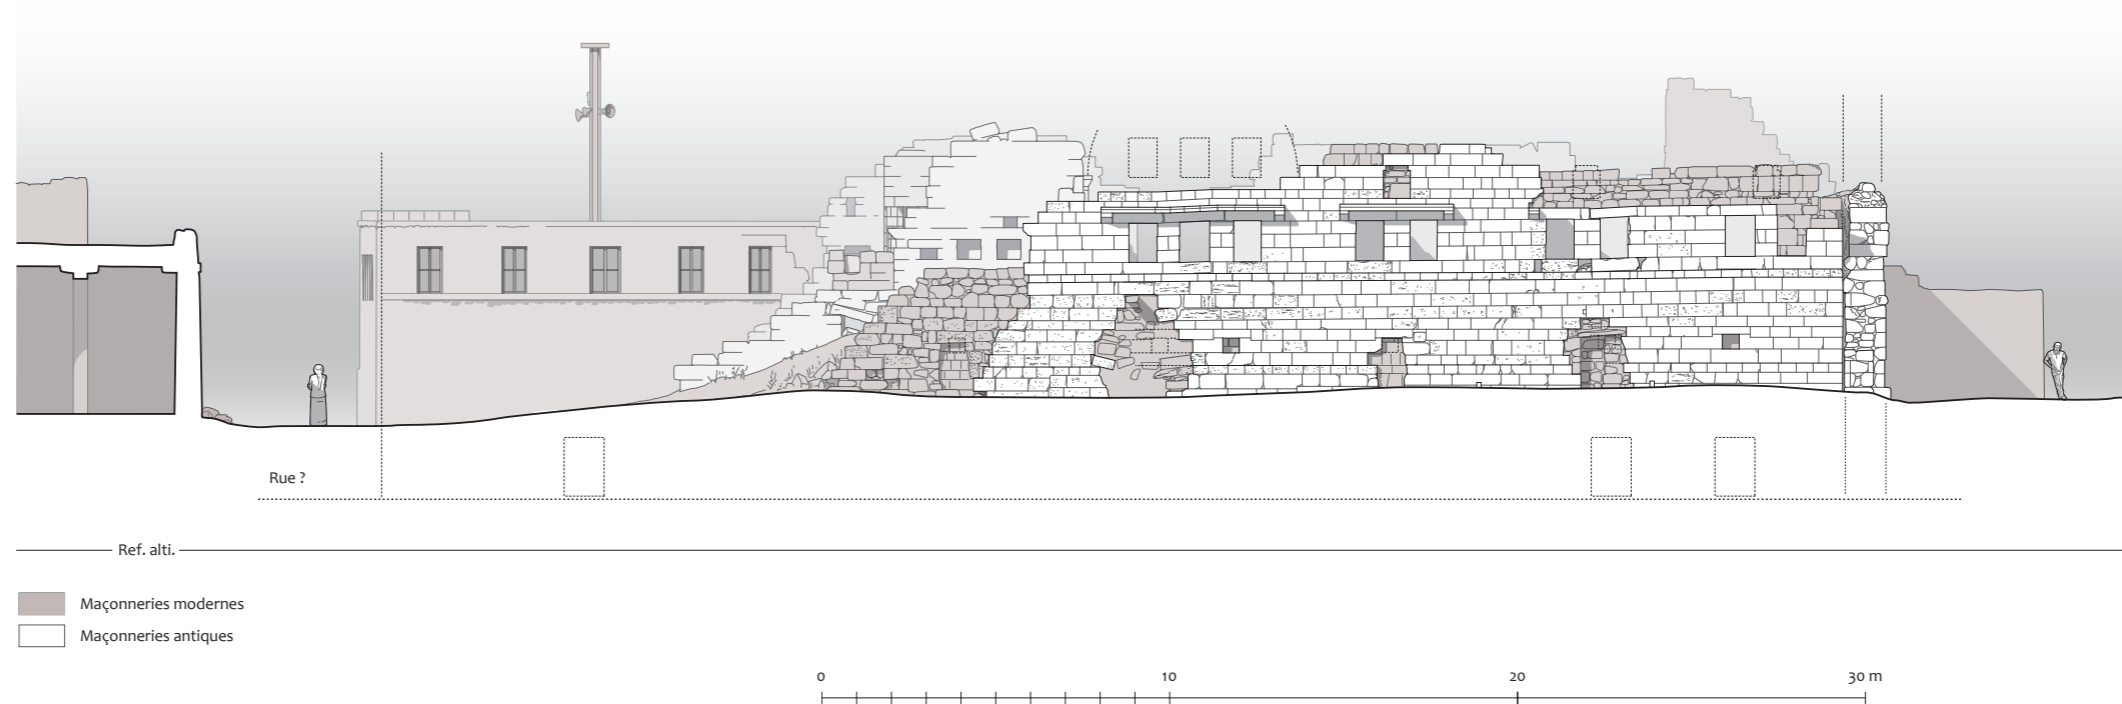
Le « Palais de Trajan », coupe 4, façade sud sur rue. Bâtiment sud (état des lieux 2009, 1/200^e)
